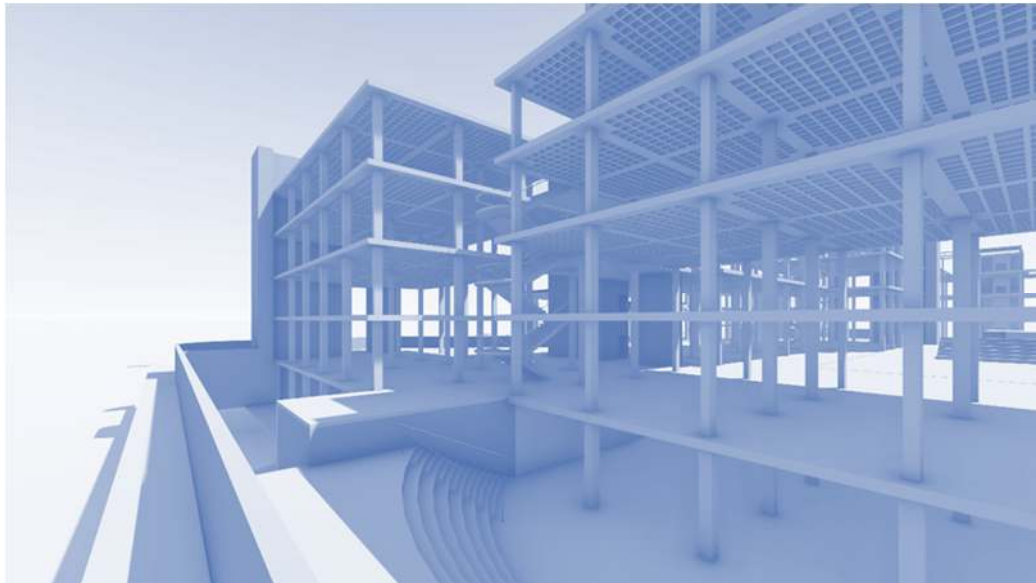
Vista 3D exterior de la estructura del proyecto. - Fuente: Elaboración propia.
